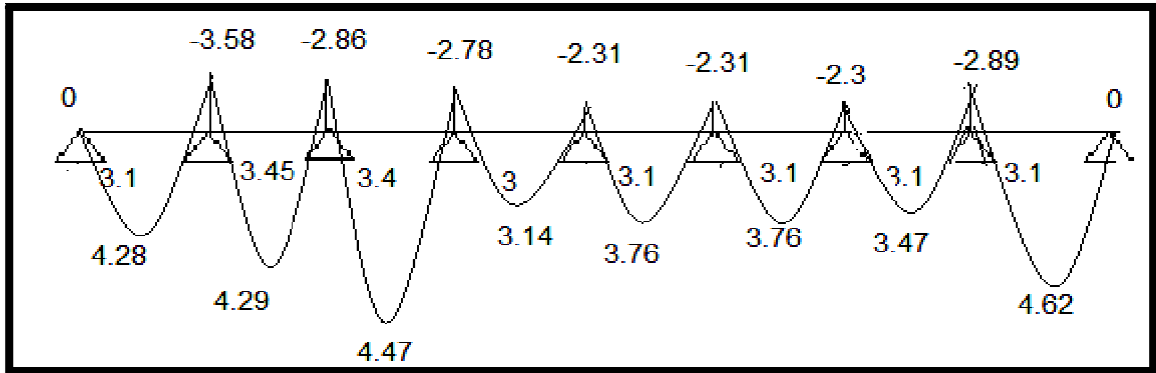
Diagramme des moments à l'ELS des poutrelles du plancher Plancher terrasse (type 2)
